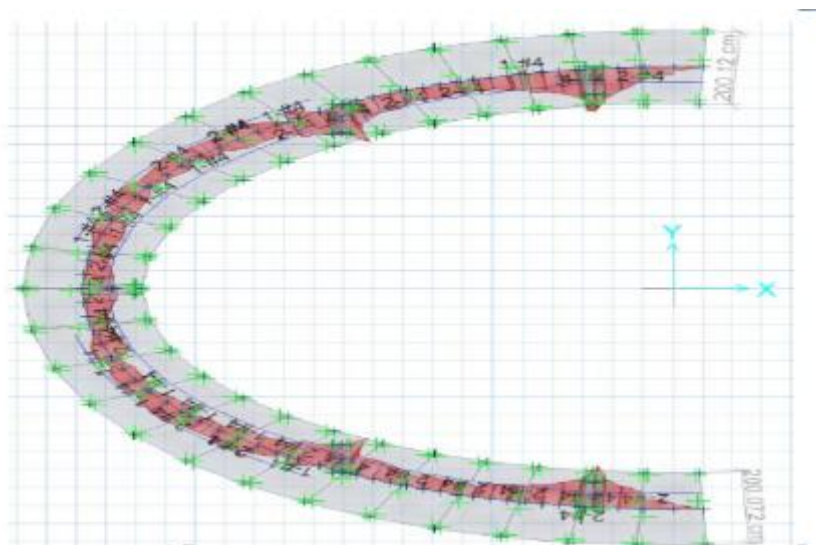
Cálculo de Refuerzo en losa de cimentación - acero longitudinal salón de usos múltiples.
